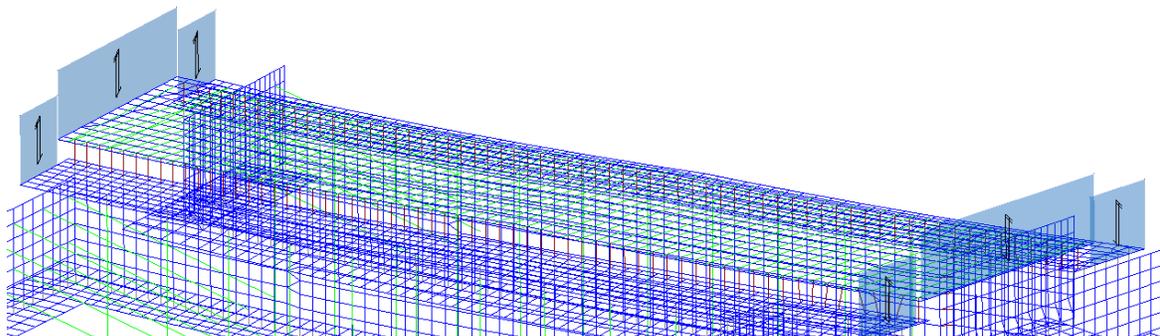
Modello 3D - Particolare elementi solaio per l'attribuzione dell'azione del vento
